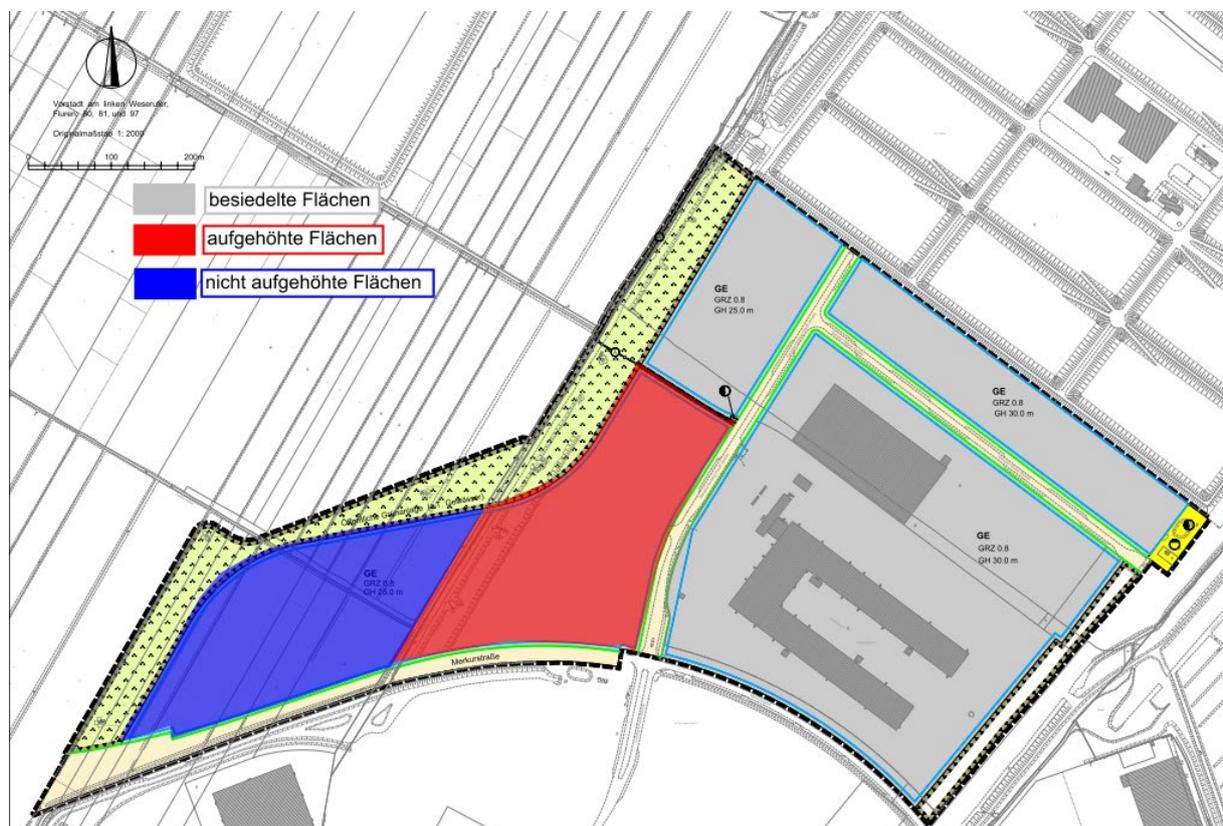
Bebauungsplan 1983 - 2. Bauabschnitt GVZ
